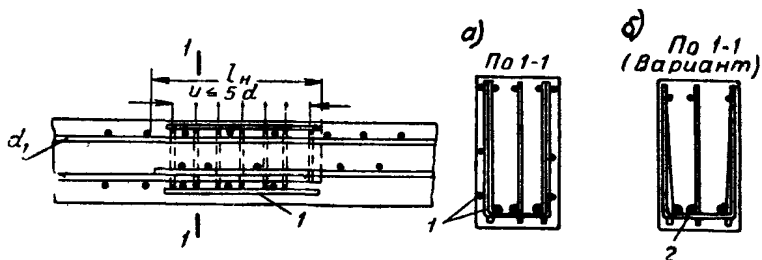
Дополнительная поперечная арматура в стыках сварных каркасов, осуществляемых внахлестку без сварки
